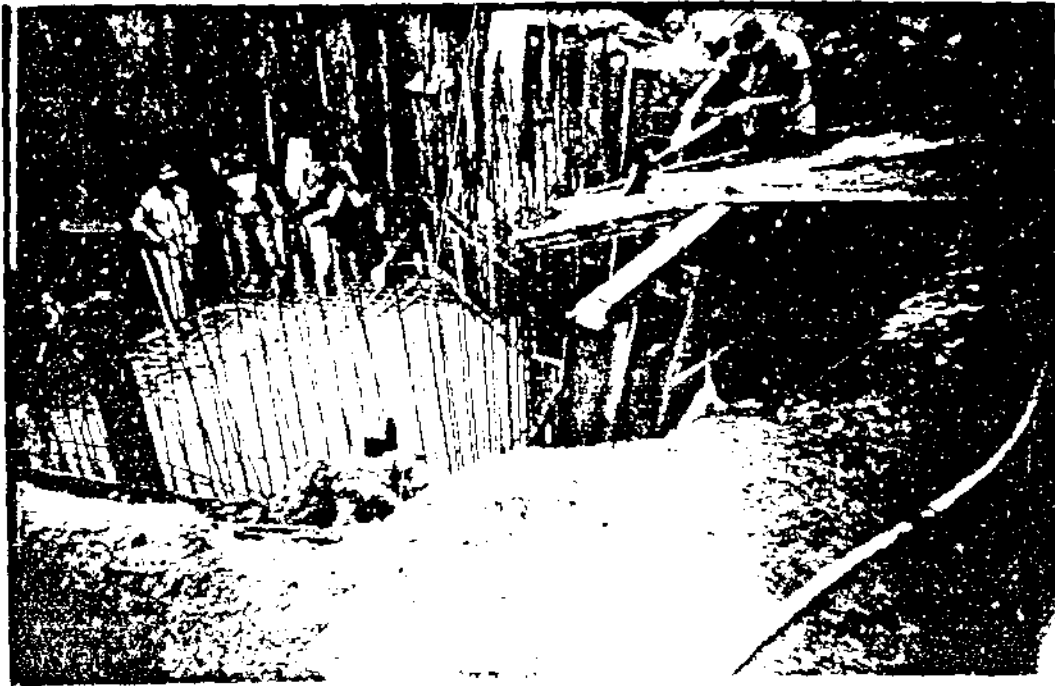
Vista del muro de contención de la zona de desahogo.
